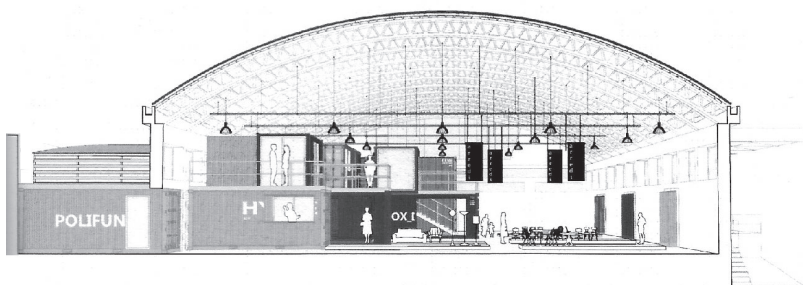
Progetto del Centro di riuso: sezione prospettica [Elaborazione Martina Pappalardo].
